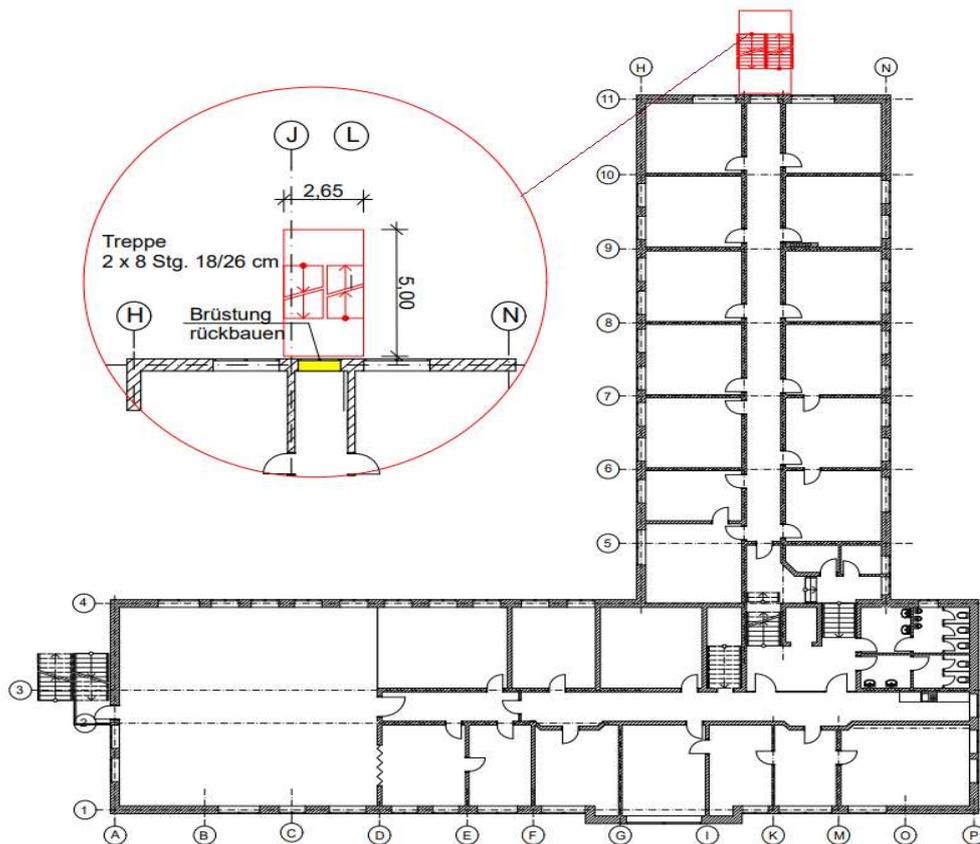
Grundriss mit Stahlterppe ohne Maßstab
